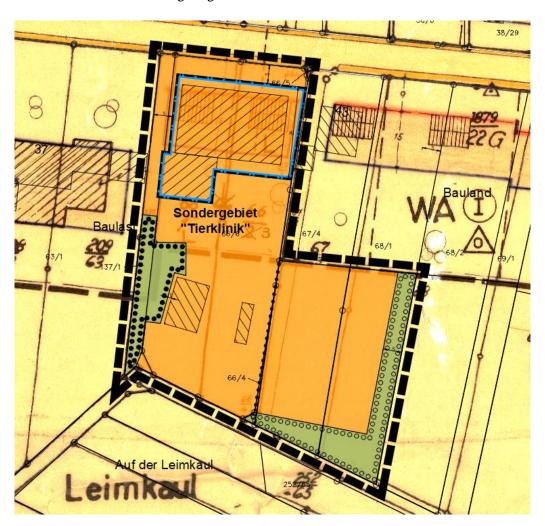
Bebauungsplan-Konzept mit hinterlegtem Stammplan von 1970
